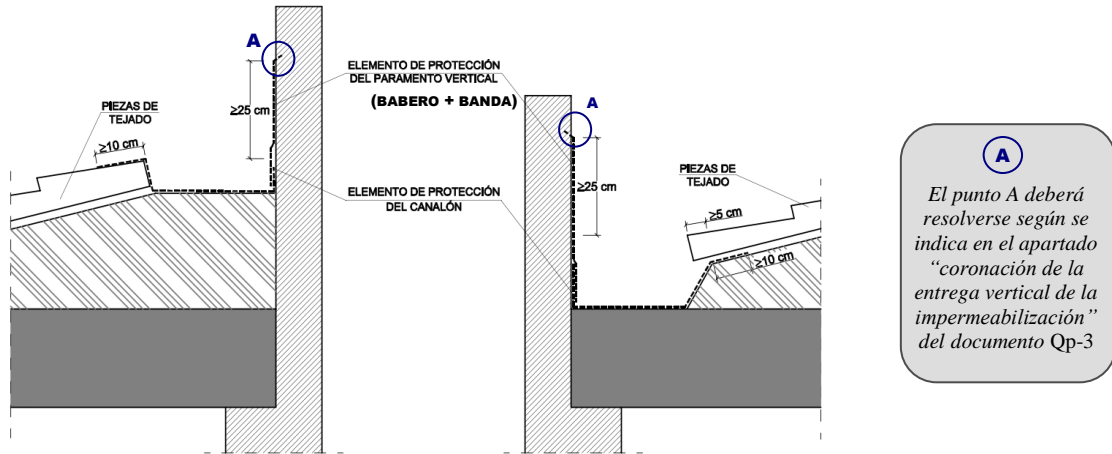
Esquema del encuentro de un canalón empotrado con un faldón de cubierta inclinada:
